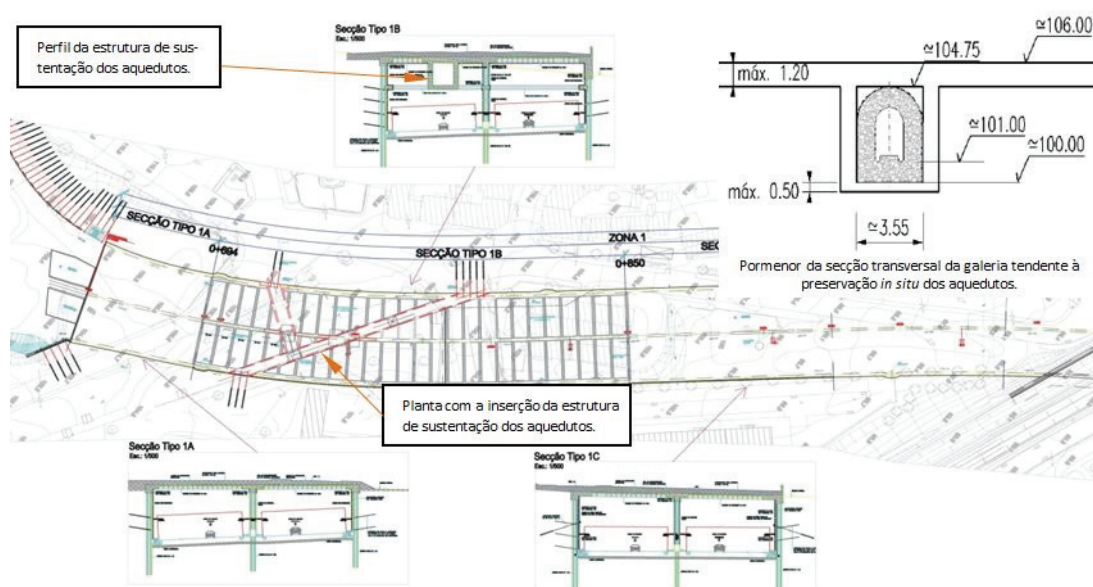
Perfil da estrutura de sustentação dos aquedutos e sua inserção na planta de projeto.
